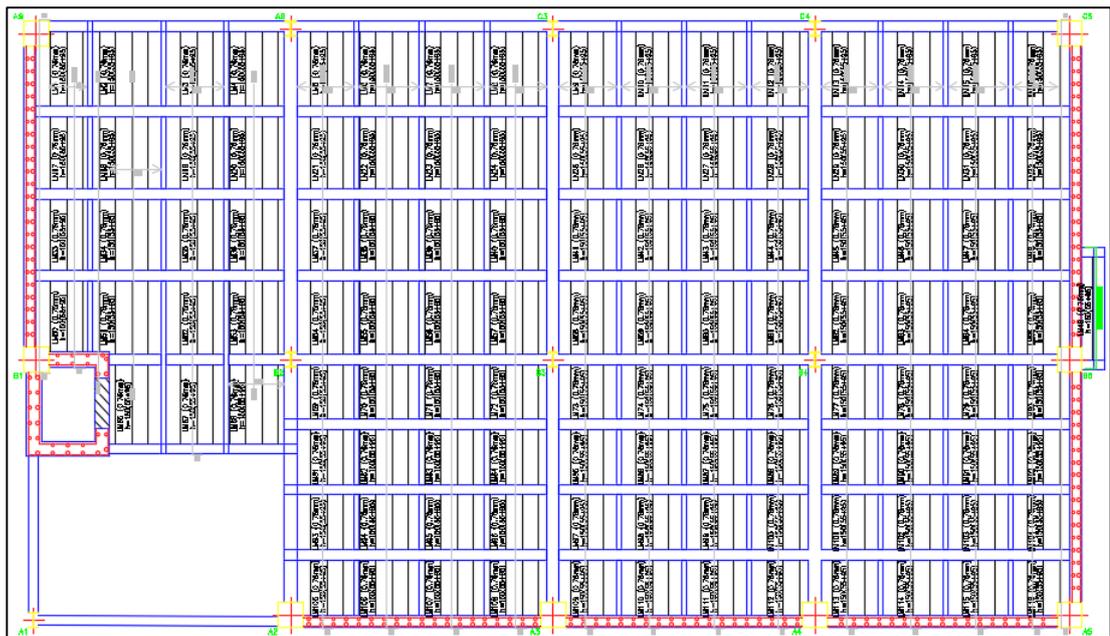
Esquema de la distribución de losa en planta N+1,62 (Acero)
